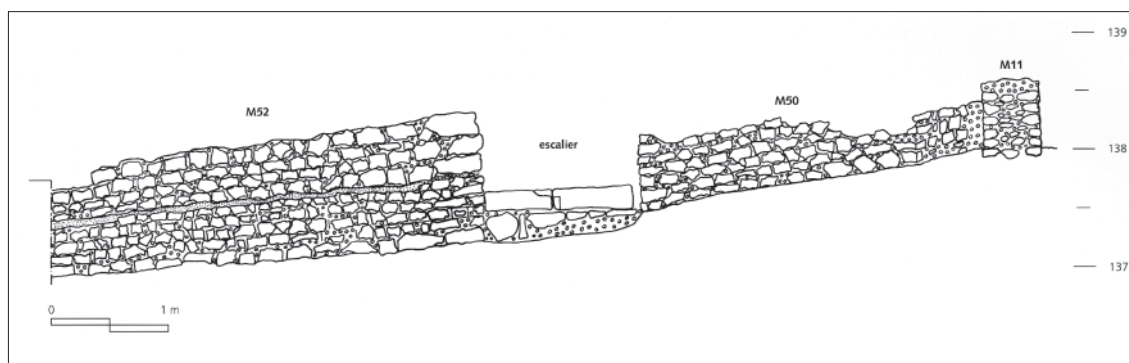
Premier théâtre. Elévation d'un des murs rayonnants construits à l'état 2.
